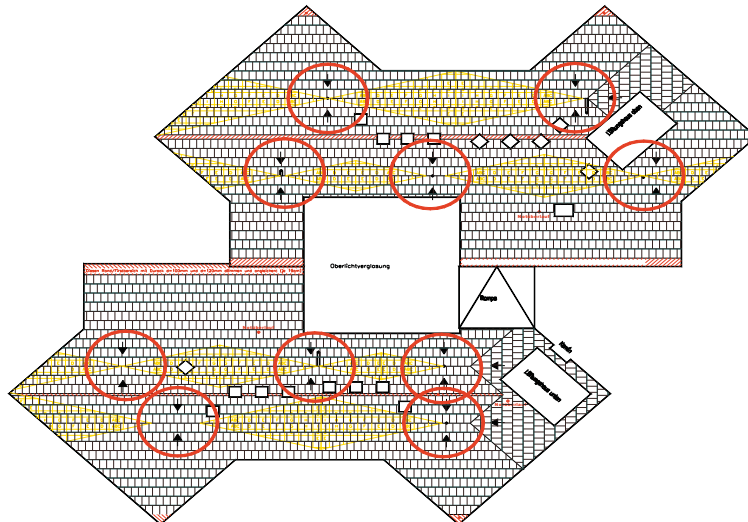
Entwässerungstiefpunkte auf einem Dach, erzeugt durch Gefälle-Dämmplatten
